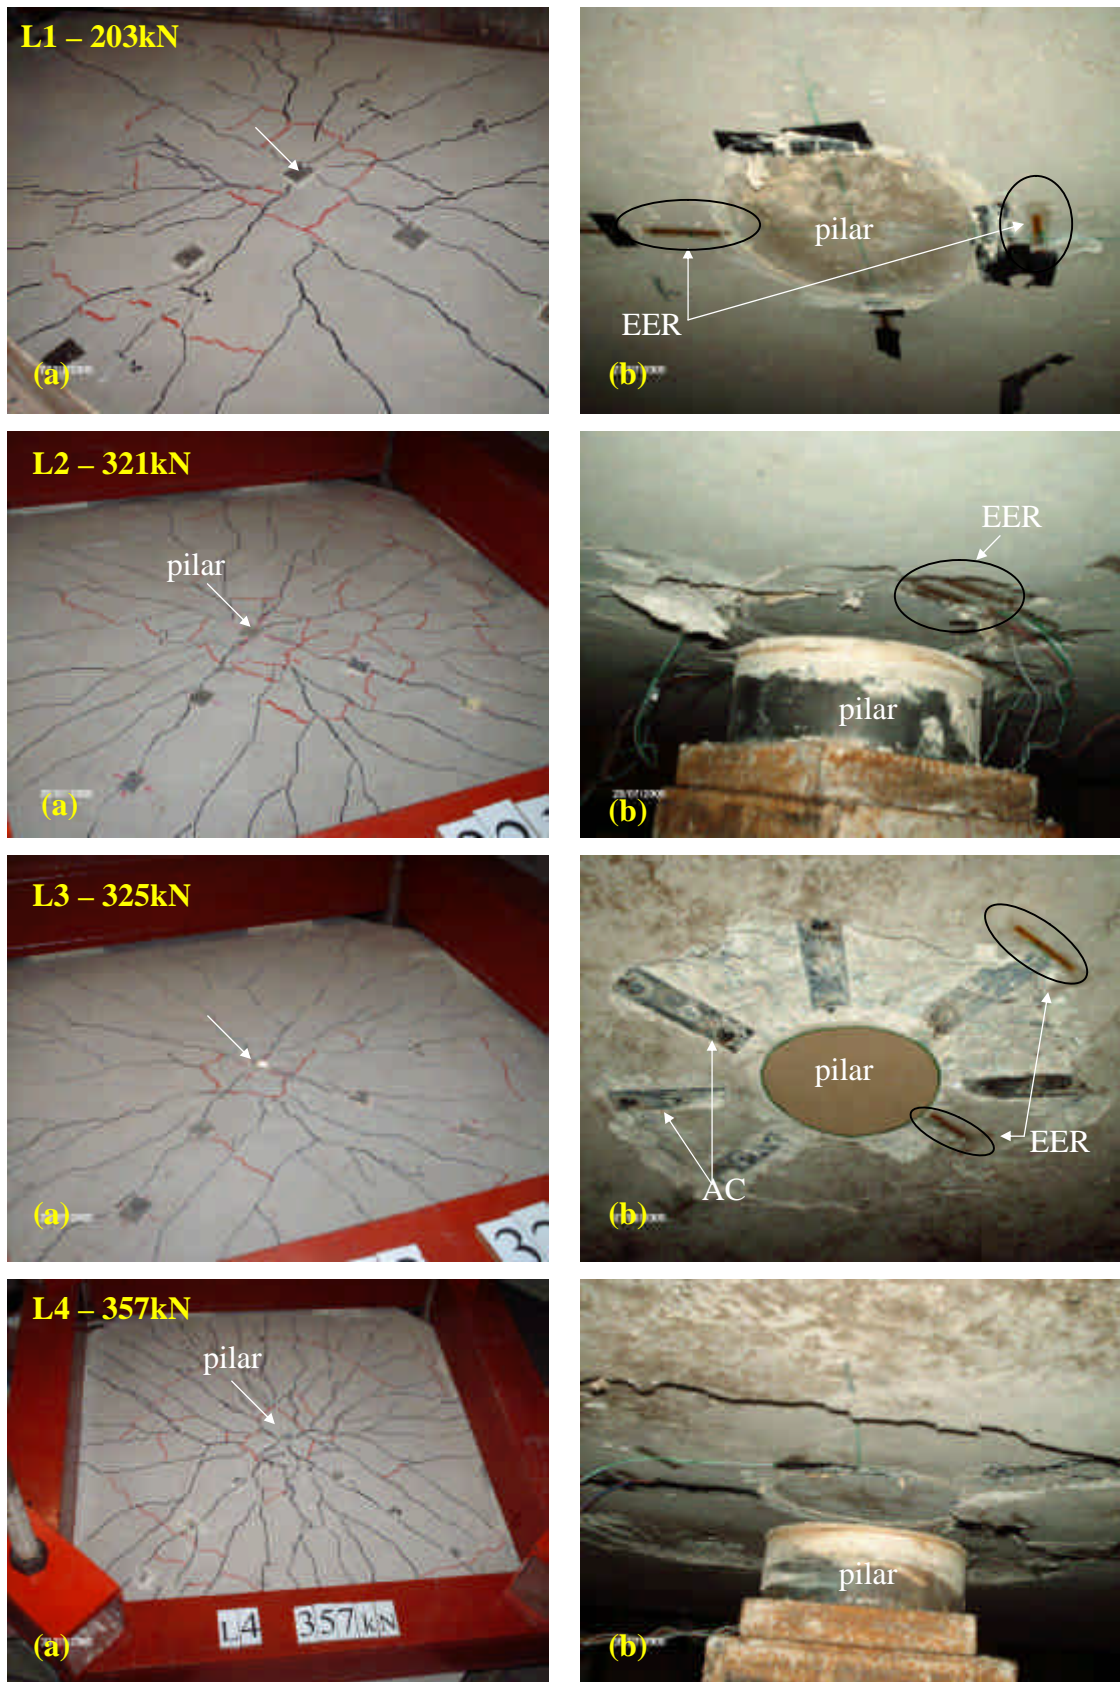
Fotografias das lajes do Grupo 1 após a ruptura – (a) Vista superior;
